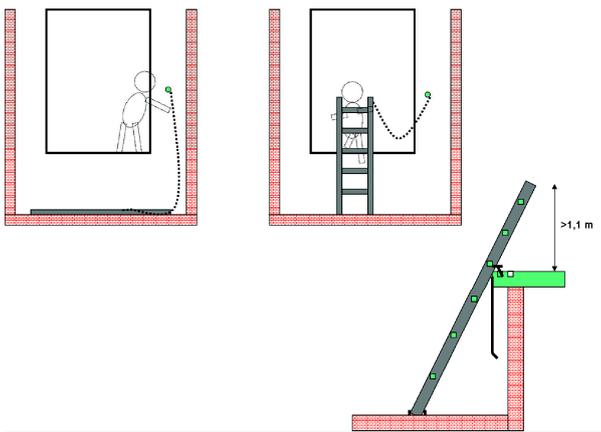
Typ 3b - Bewegliche Schachtgrubenleiter
